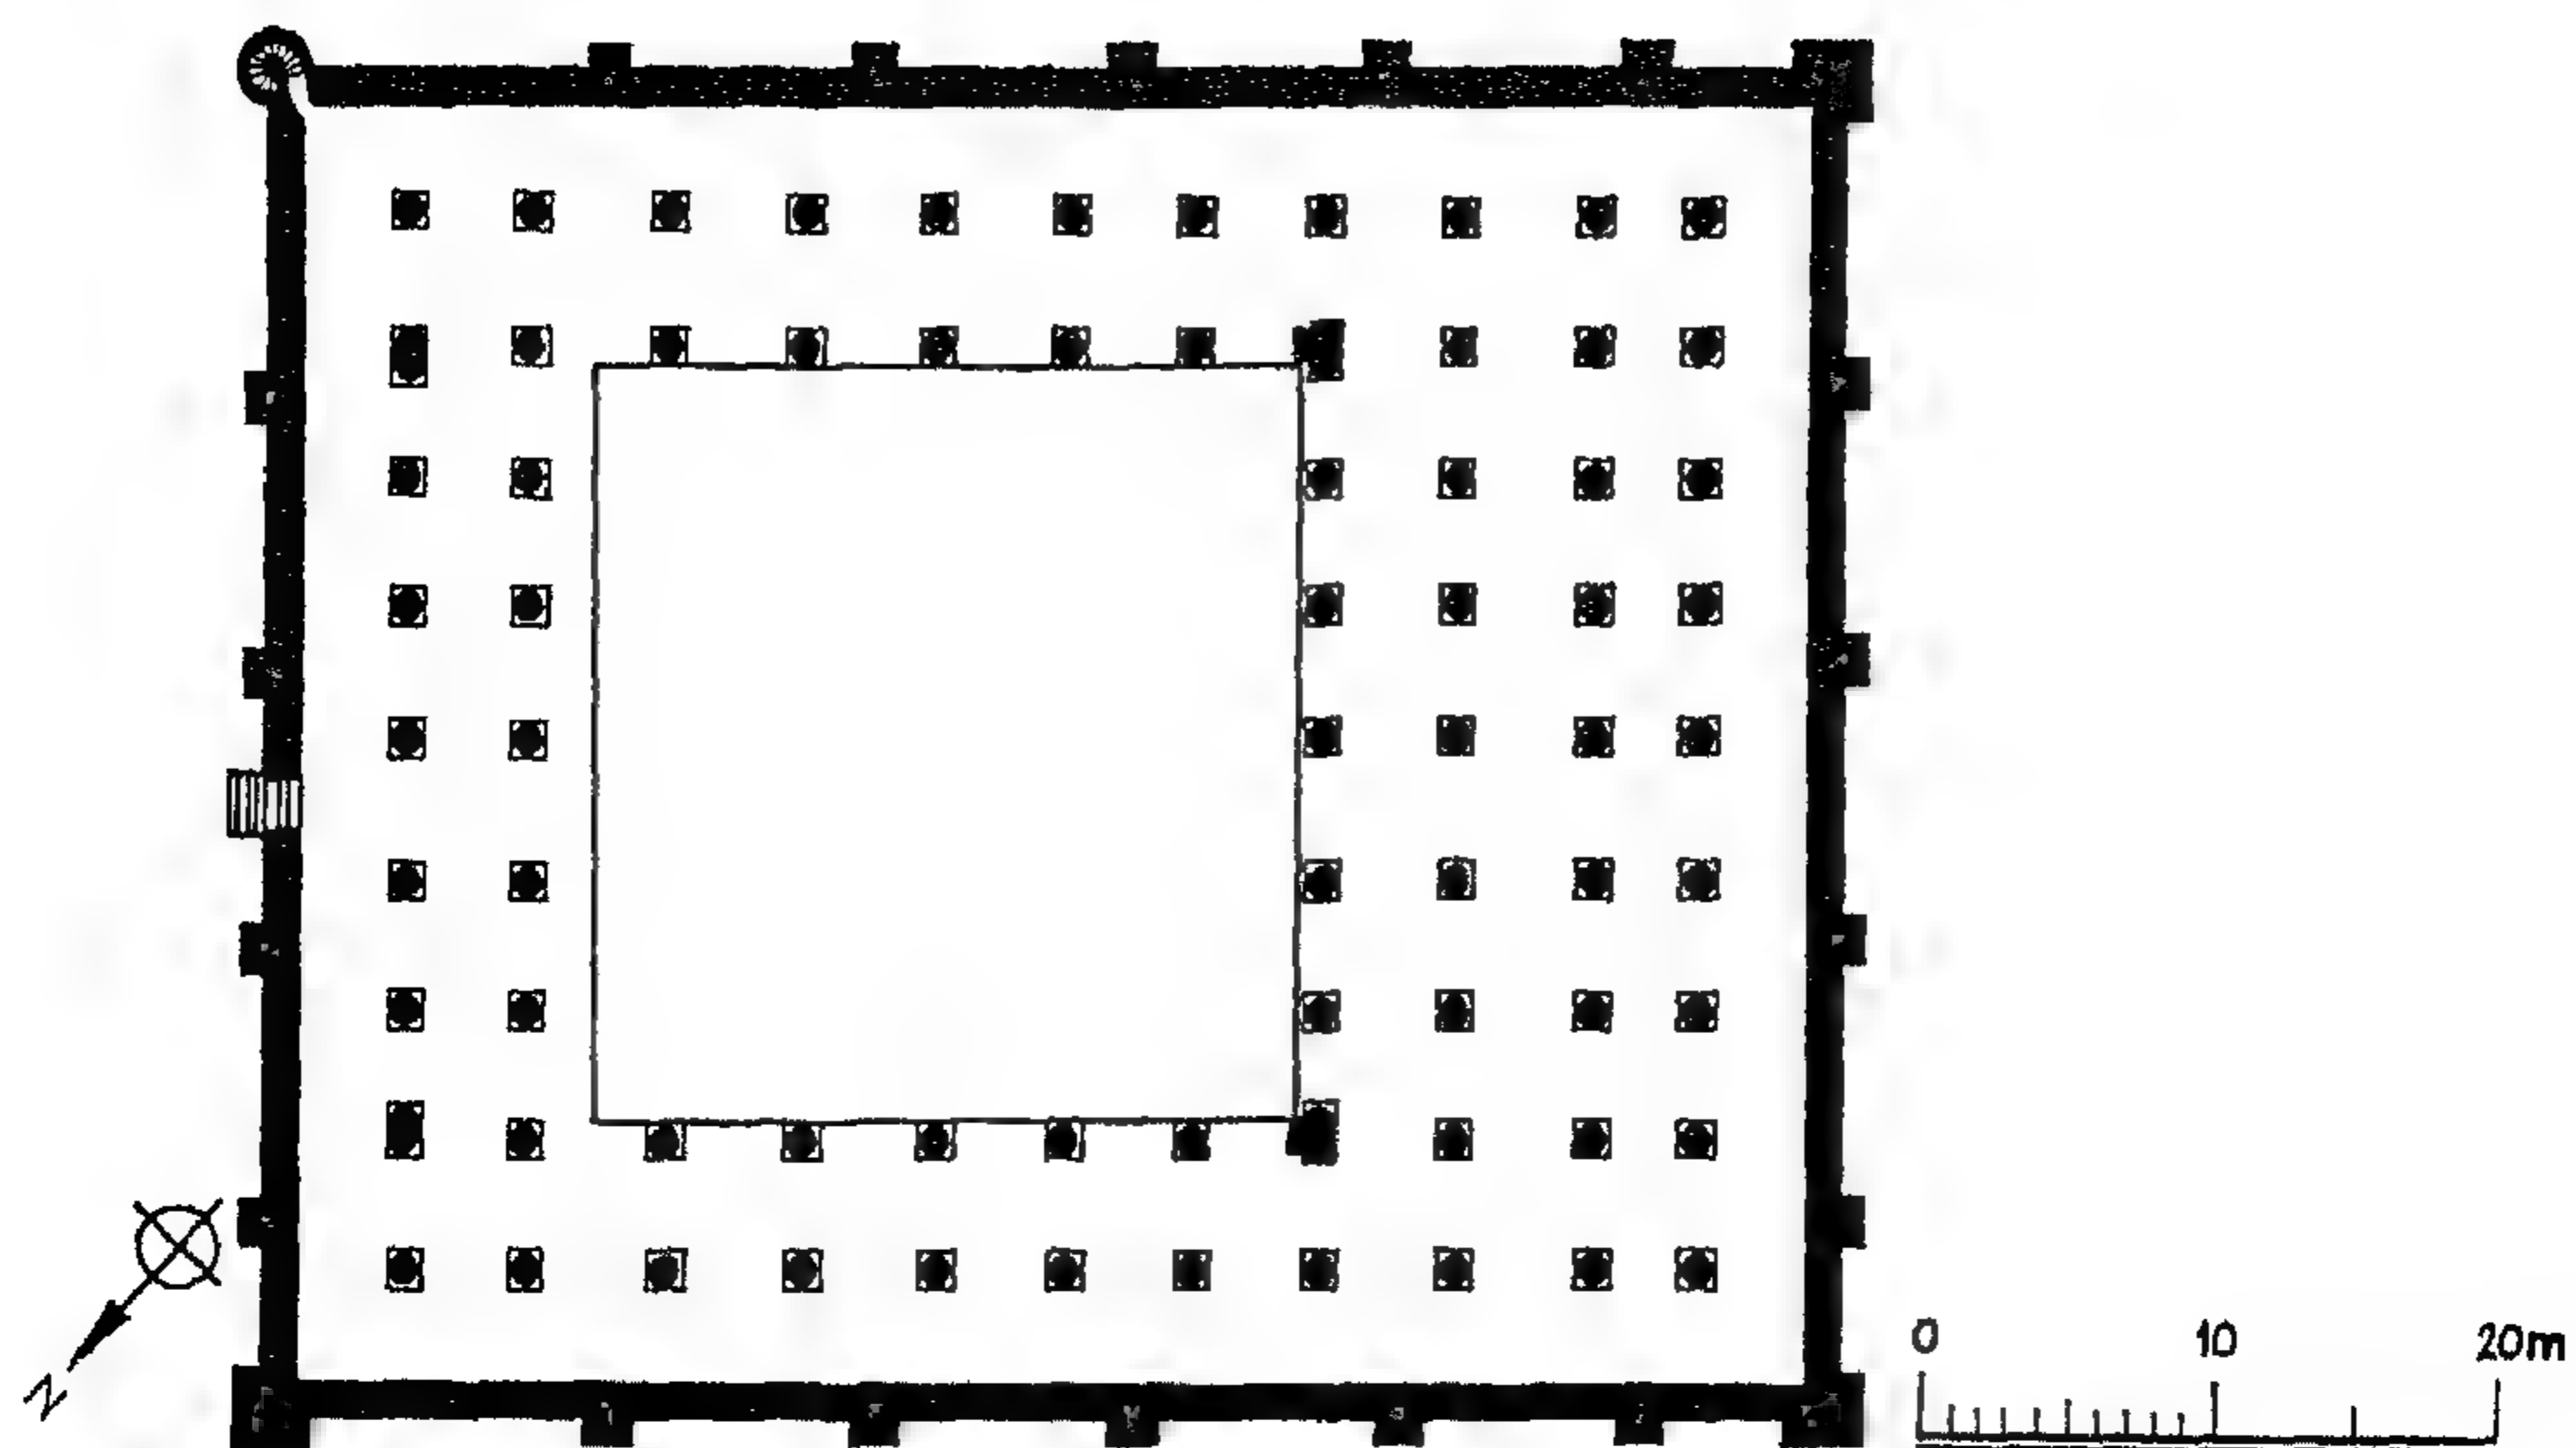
مسقط أفقي لرباط سوسة بتونس . (عن : كريزول) .
